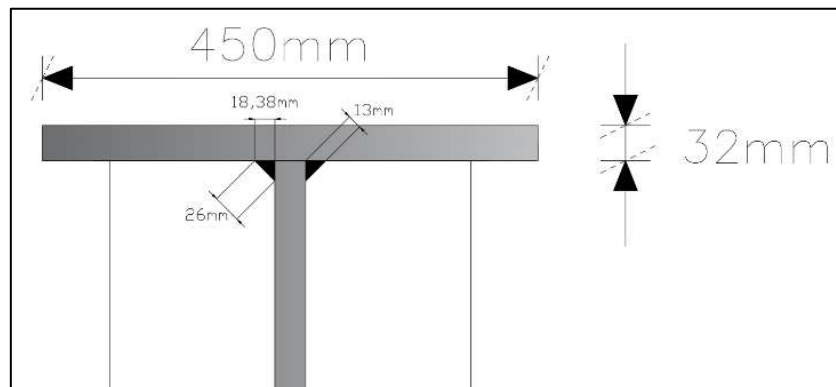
Soldadura de filete entre el patín inferior y superior con el alma de la viga. (Sección Transversal-Detalle).
